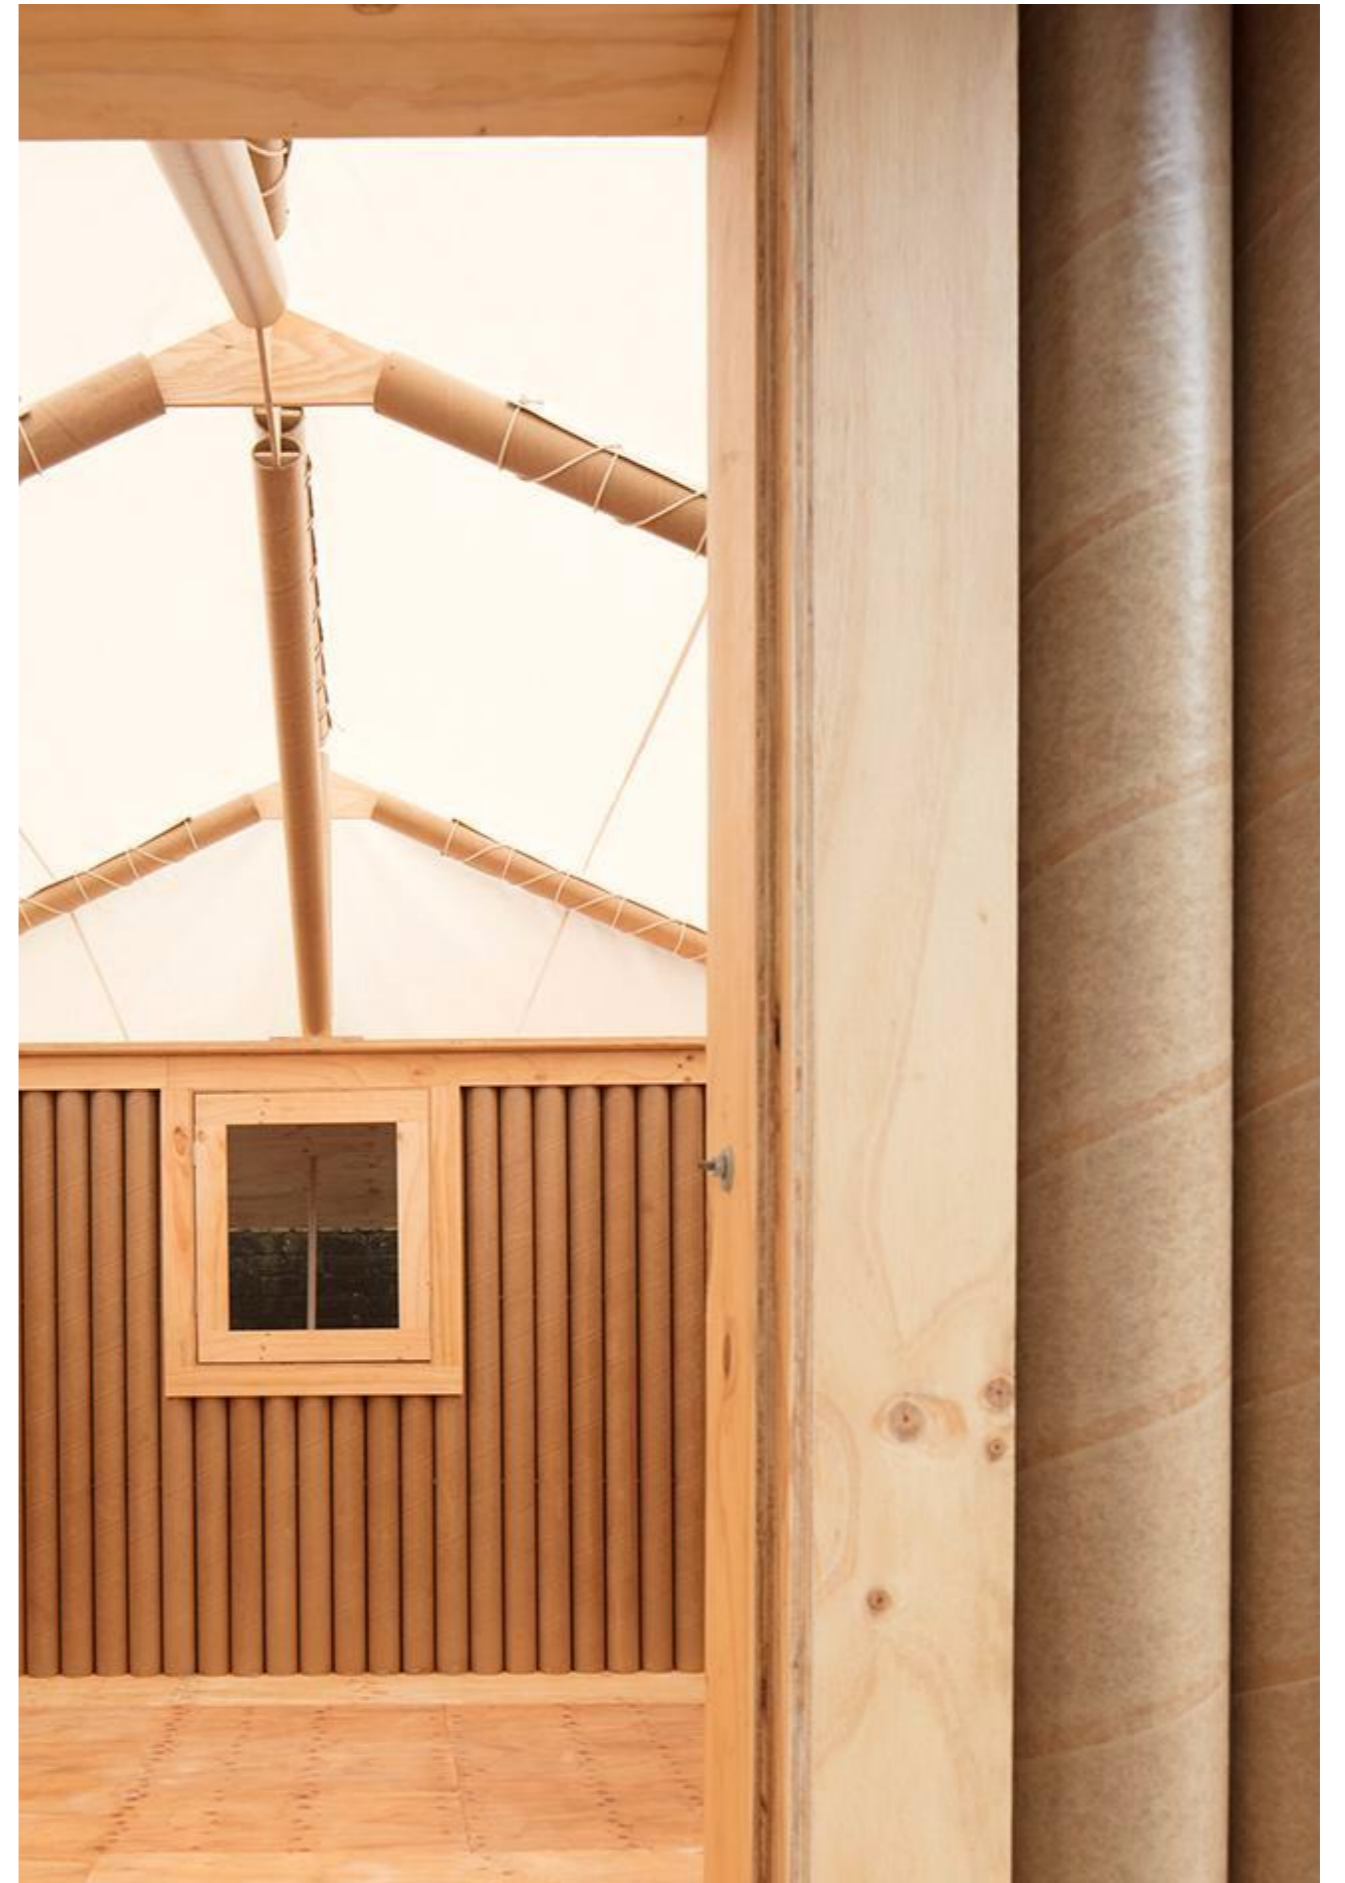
Pieza de ensamblaje de cubierta. Paper Log House, Kobe, 1995.
